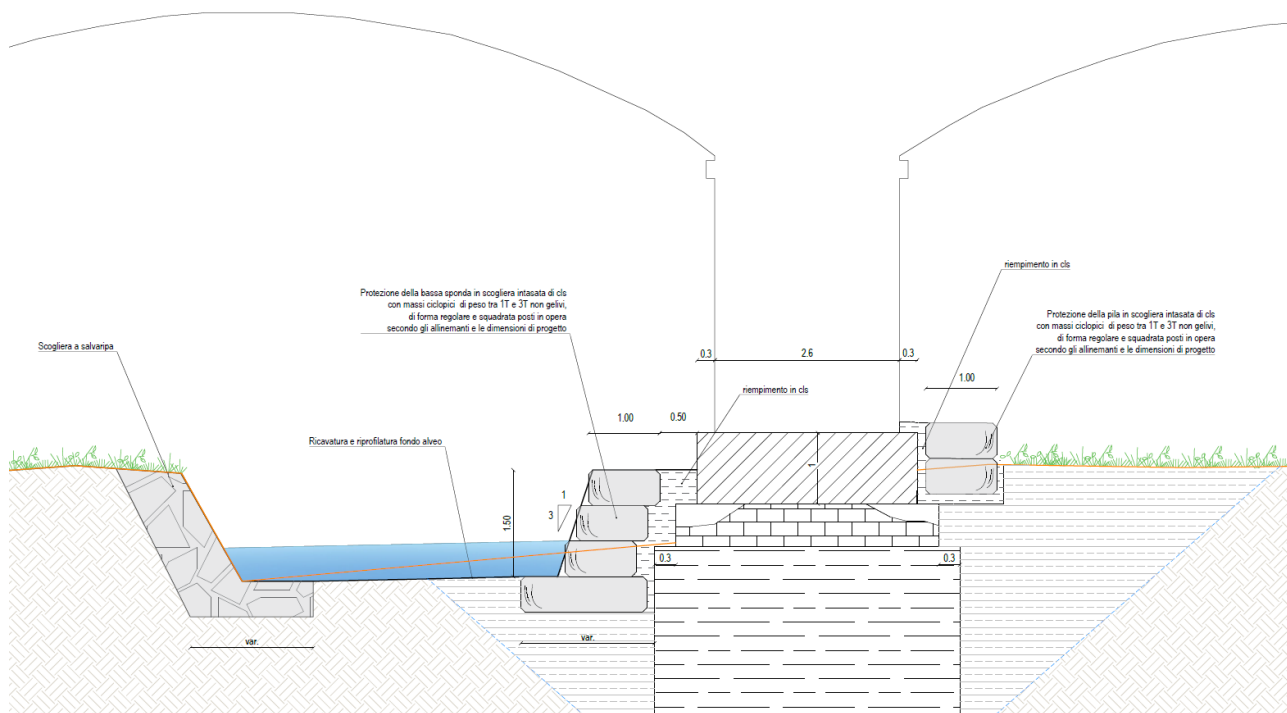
sezione interventi sulla sistemazione idraulica delle sponde
